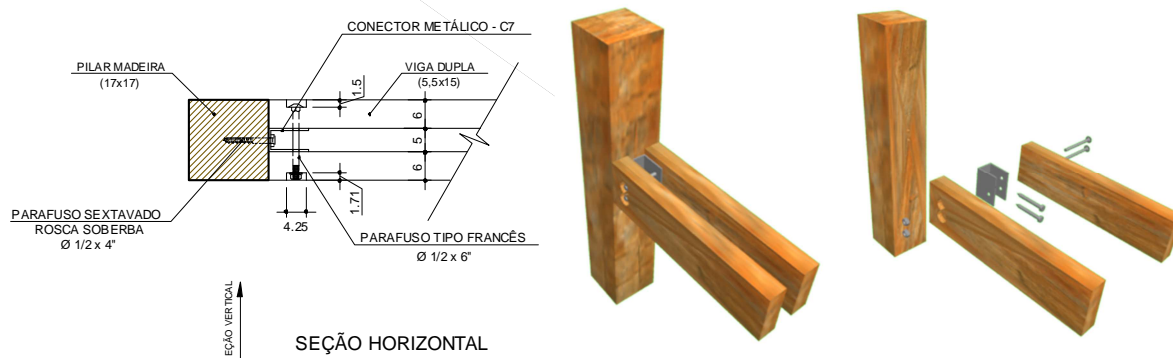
Edificação Sousas - Projeto e imagens tridimensionais da interface pilar–viga dupla.
